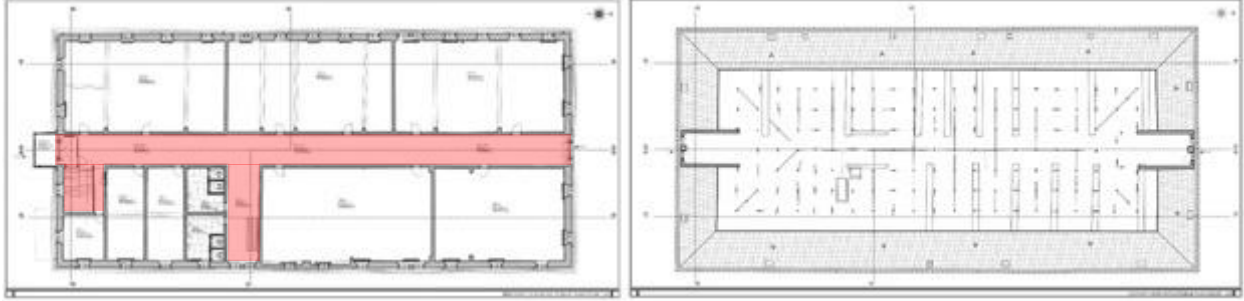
Birinci kat ve çatı katı planı rölöve çizimi (Uzaslan, 2021).
